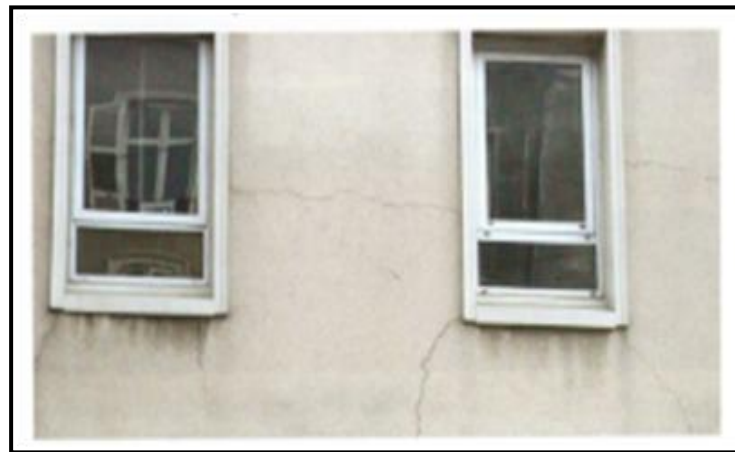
Ces fissures se sont ouvertes dans un enduit réalisé sur une façade ancienne. L'enduit a fait du retrait en excès. il s'est fissuré, notamment dans les angles des fenêtres qui bloquent sa déformation.
